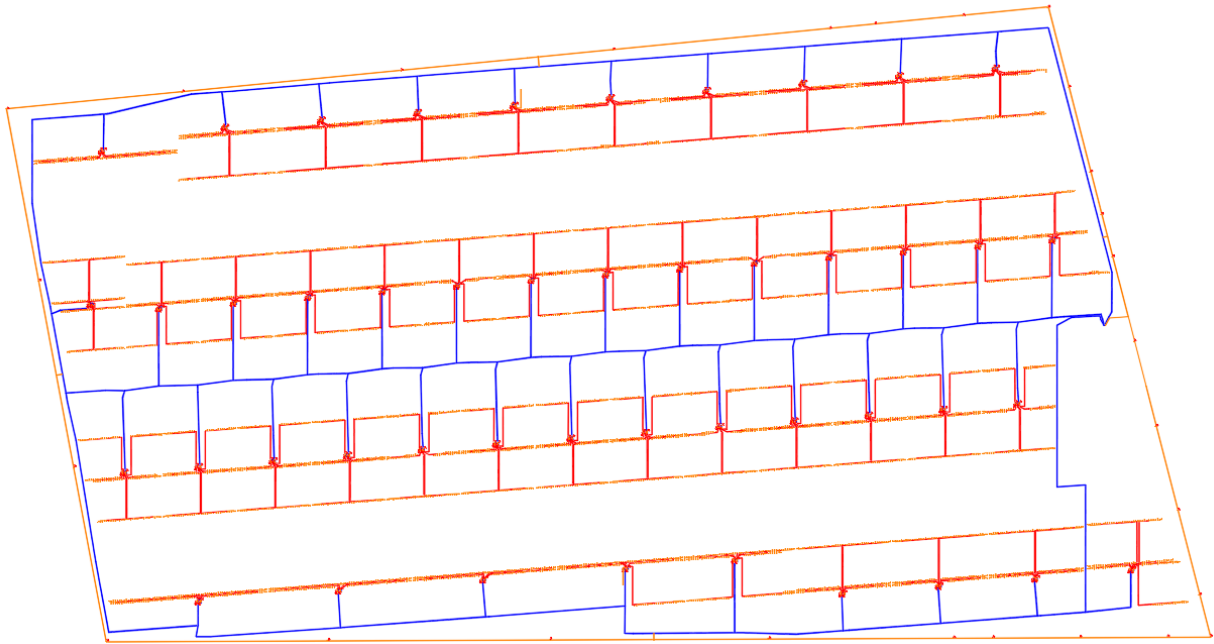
Sistema de puesta a tierra de la Planta Fotovoltaica.
